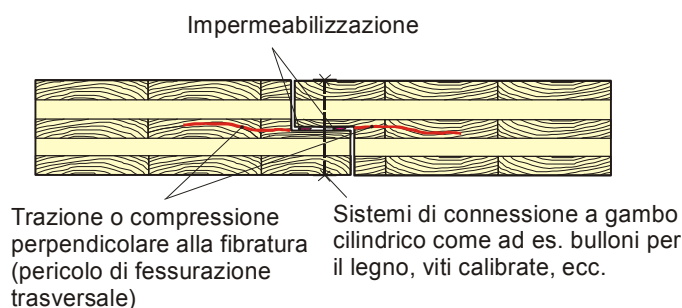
Giunto longitudinale a cerniere tra due elementi di solaio
